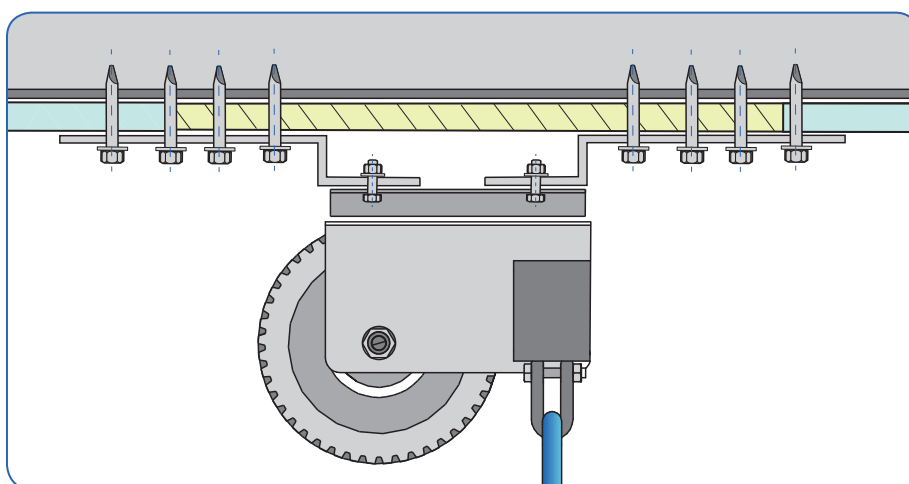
Instalación del torno en la cubierta. VISTA DE PERFIL
